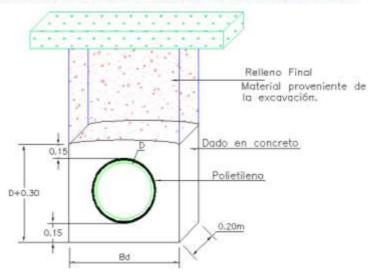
Recomendaciones de cimentación para las zonas de altas pendientes y/o cruces elevados.
